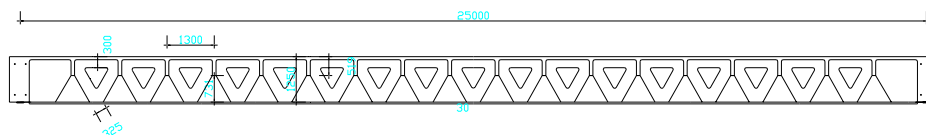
Coupe longitudinale - solution 25m - Dalle BFUP treillis et semelles en acier
